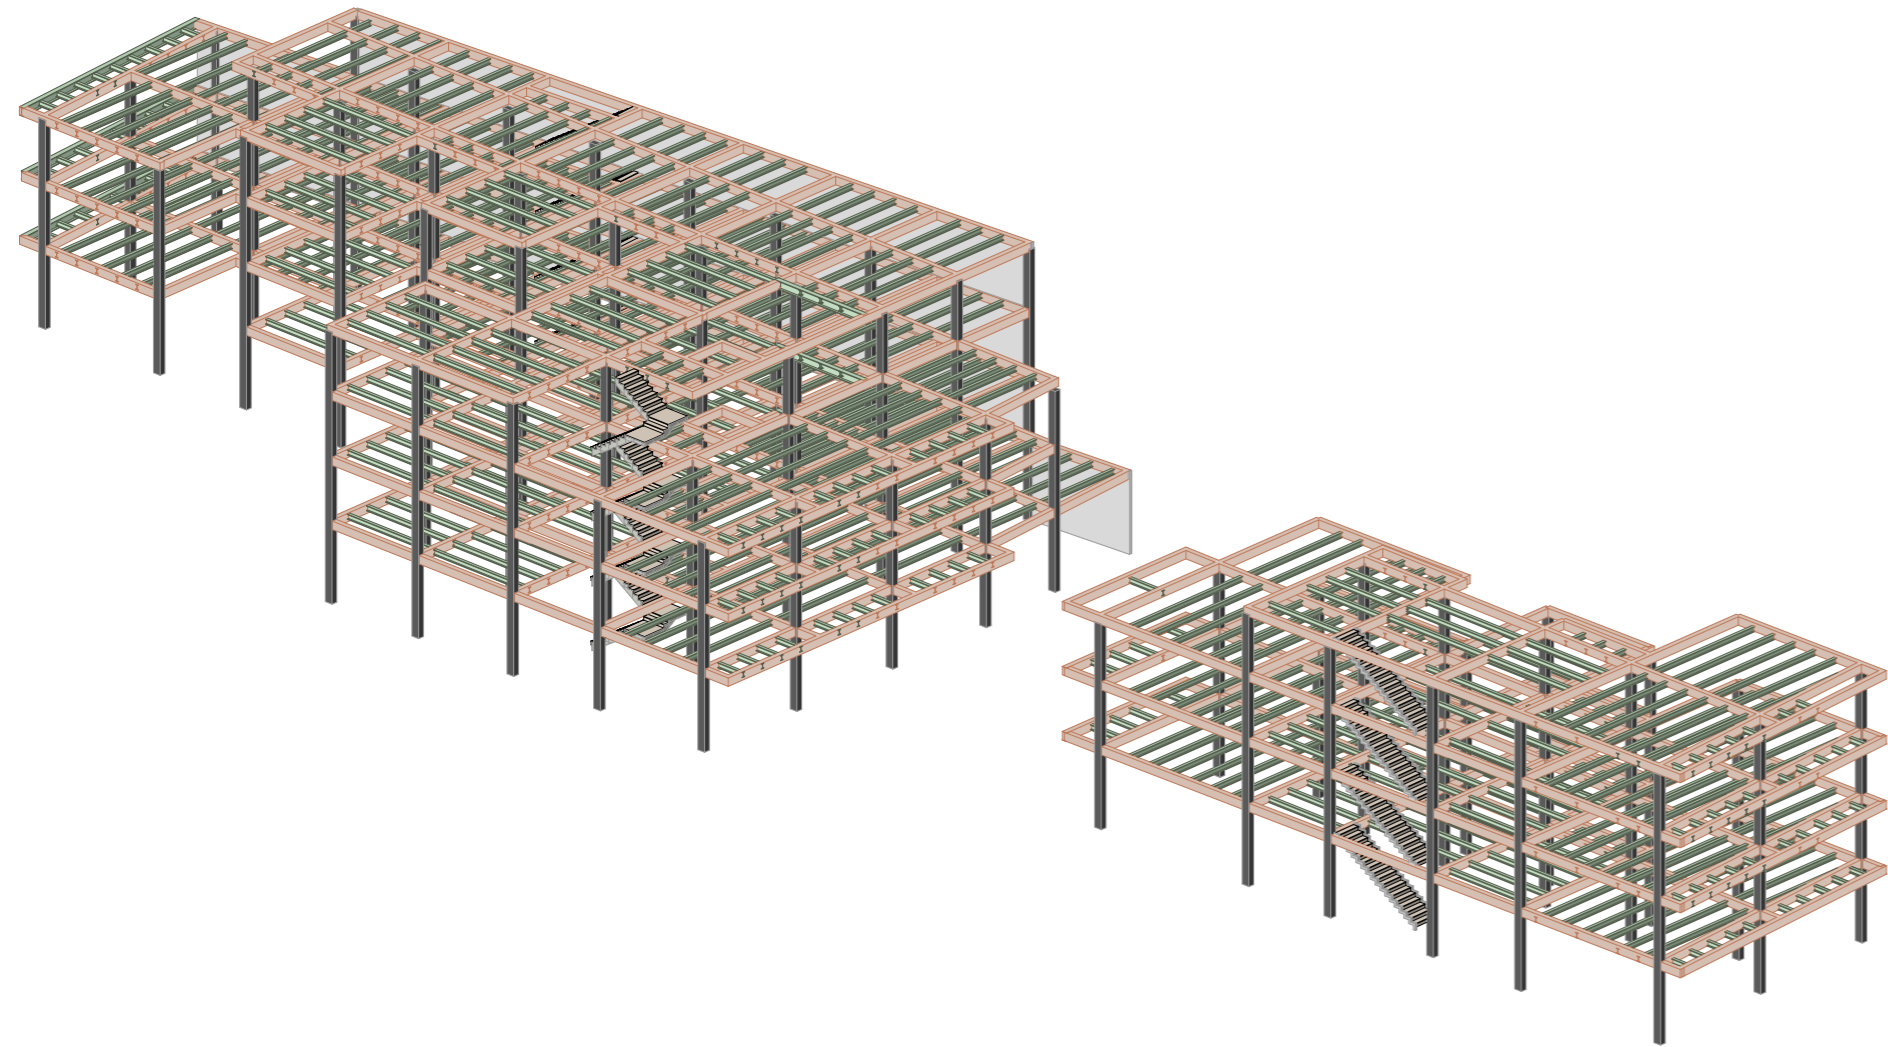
Distribución de columna, vigas y viguetas. Nota. Elaboración propia.
